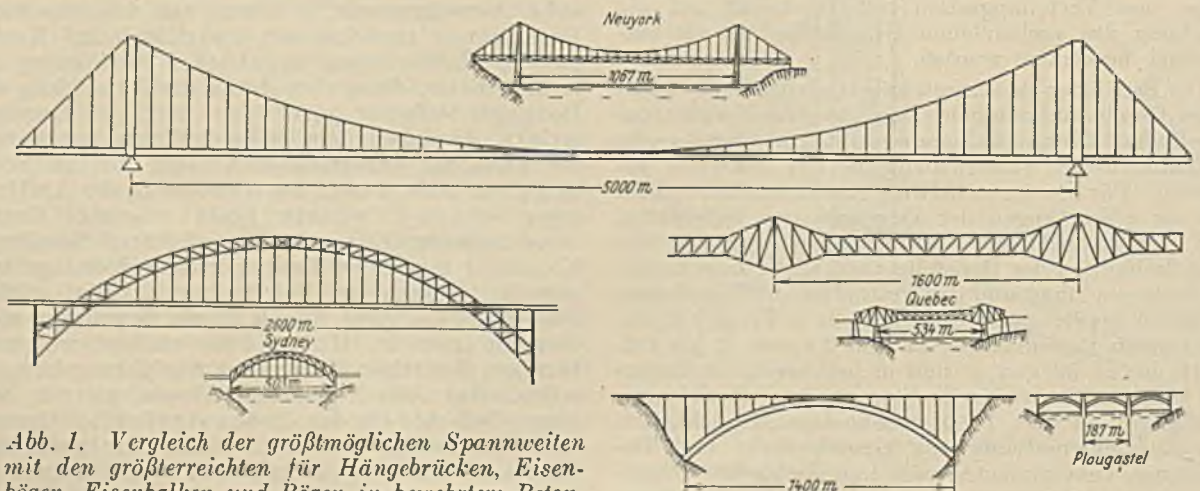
Vergleich der größtmöglichen Spannweiten mit den größterreichten für Hängebrücken, Eisenbögen, Eisenbalken und Bögen in bewehrtem Beton.
